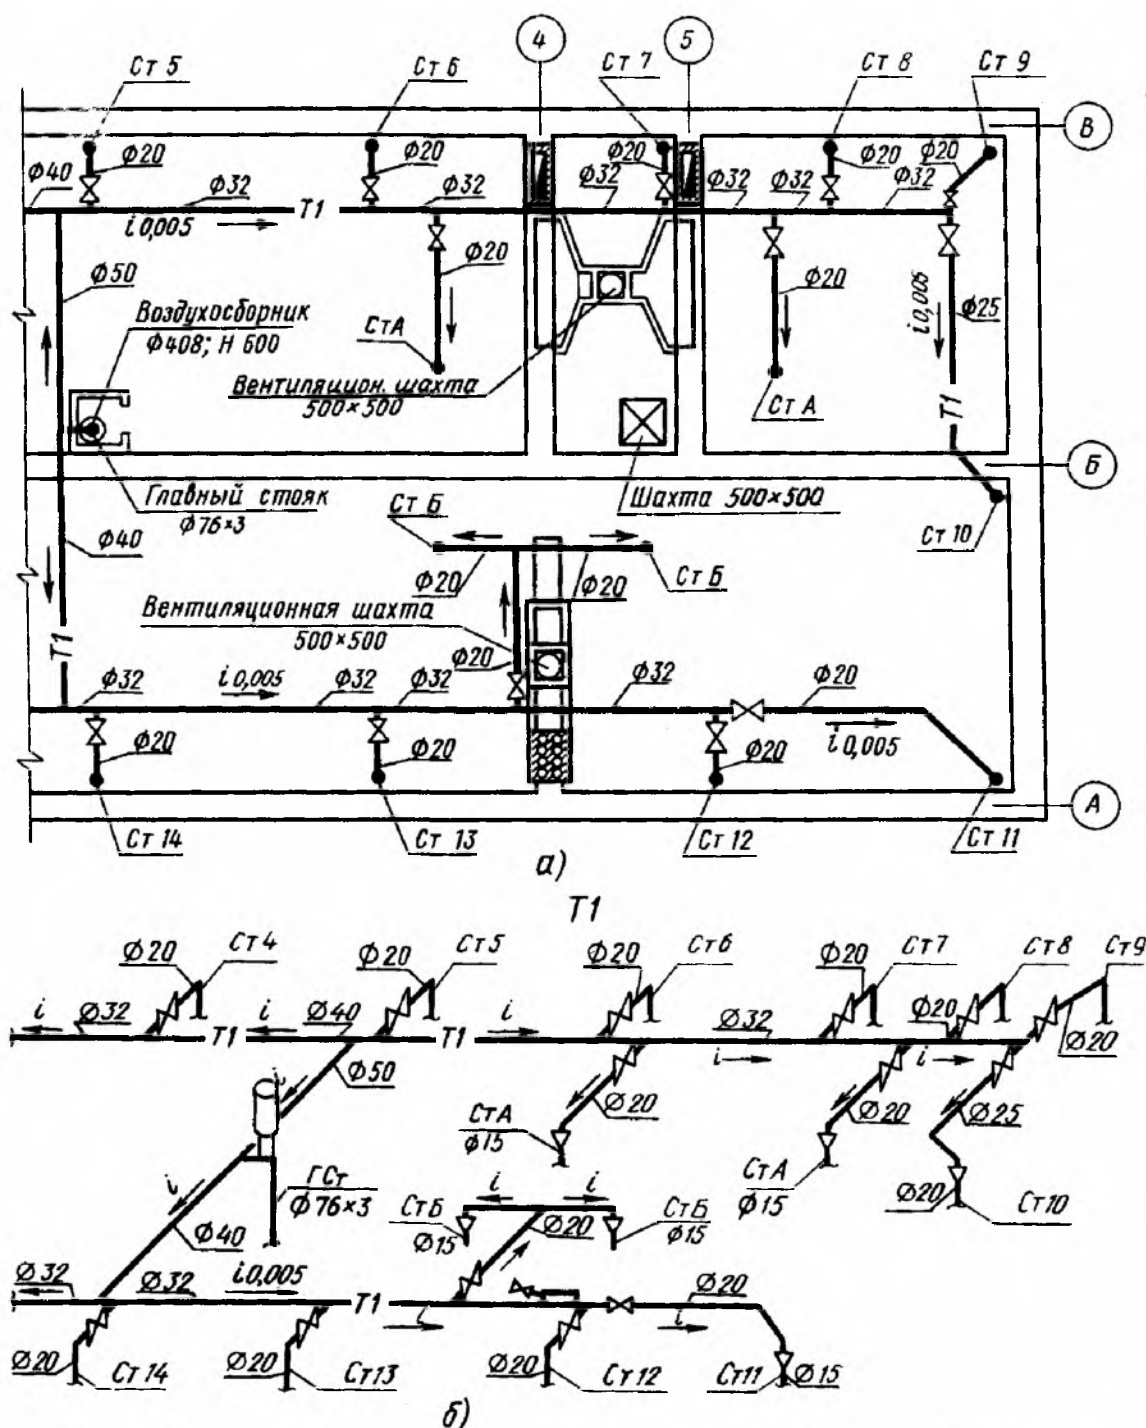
План чердака жилого здания с верхней разводящей сетью трубопроводов отопления (а); аксонометрическая схема верхней разводки (б)
